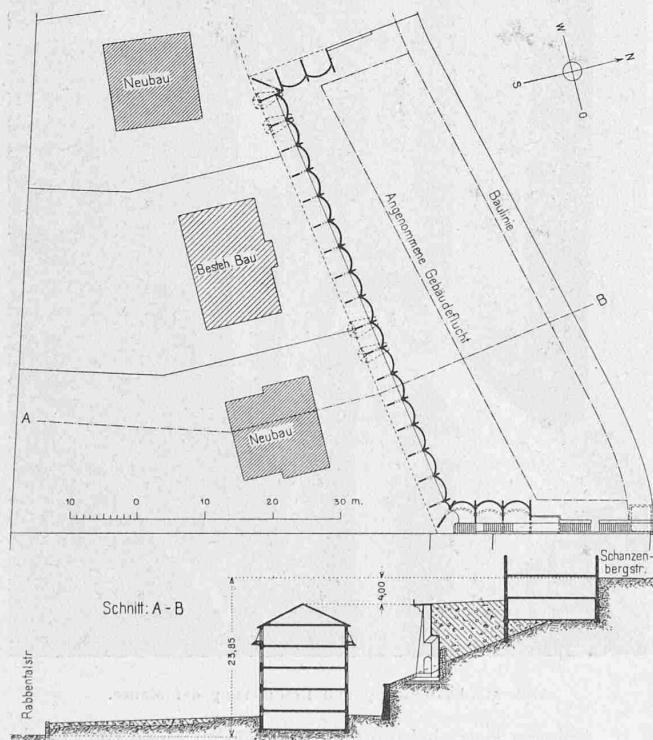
Lageplan und Querprofil A-B. — Masstab 1 : 1000.
